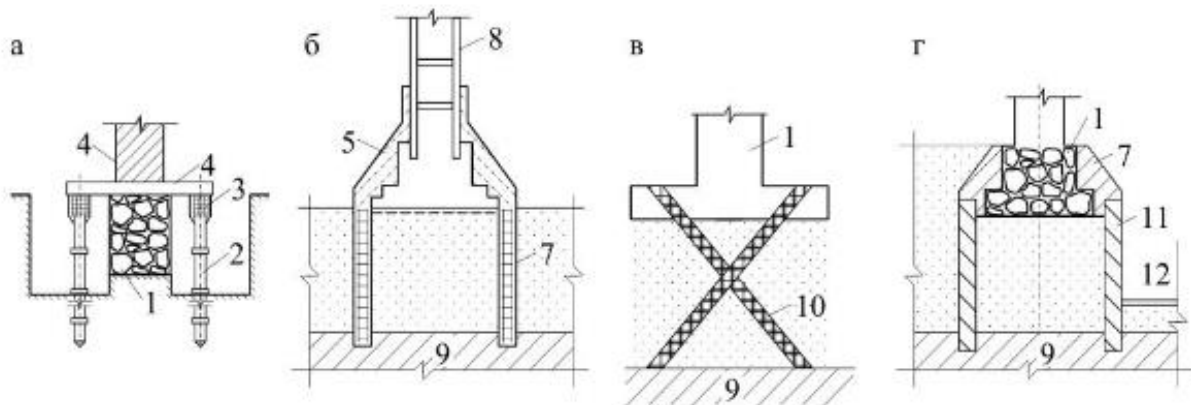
Схеми підсилення фундаментів палями та глибокими стінами:
